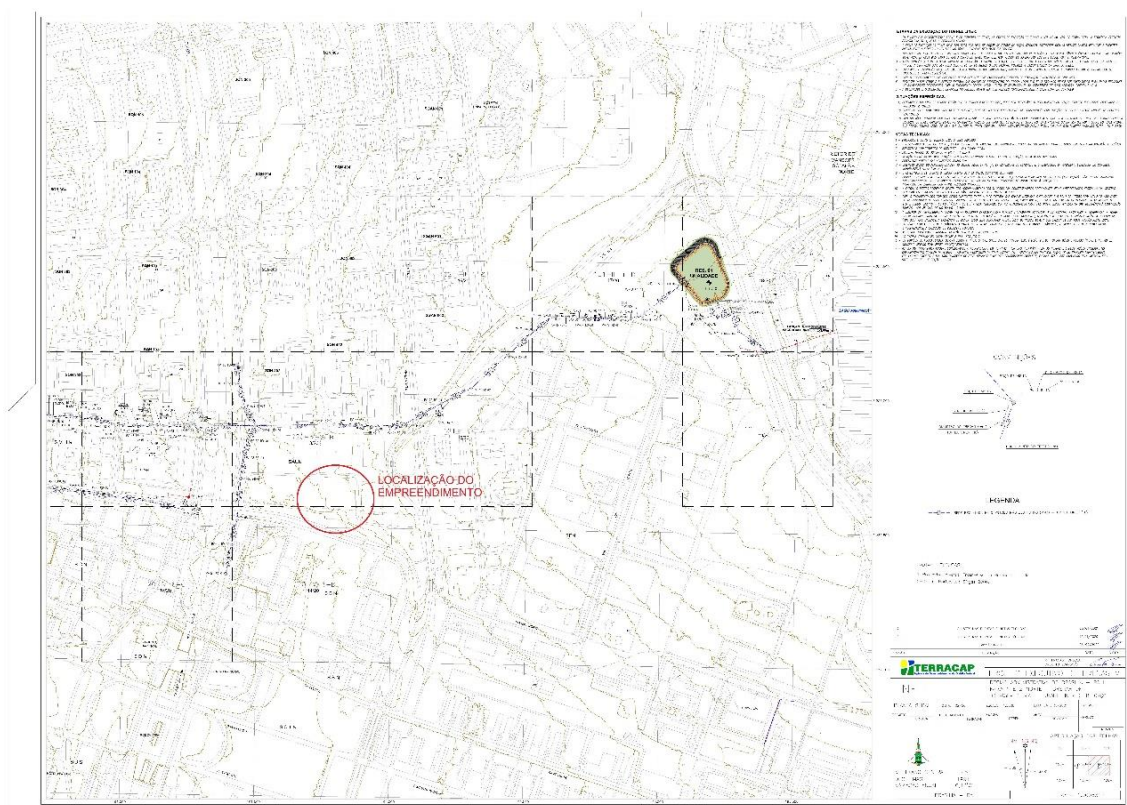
Planta Geral de projeto de drenagem de Águas Pluviais da Faixa 1-2 Norte – Programa DRENAR DF. Fonte: Terracap.
